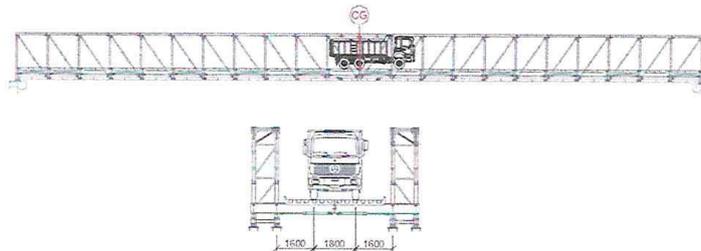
POSICIÓN DE LA CARGA DEL ENSAYO (ALZADO Y CORTE TRANSVERSAL)
